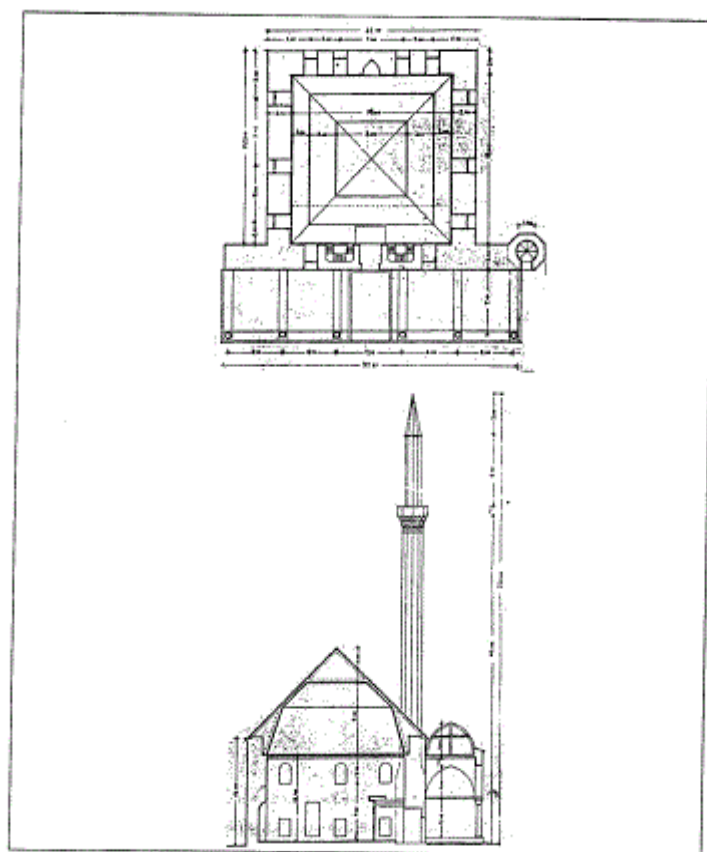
مسقط أفقي لمسجد الدفتر دار (الأرناؤوطية) في بانيالوكا (عن : إيفردى) .
